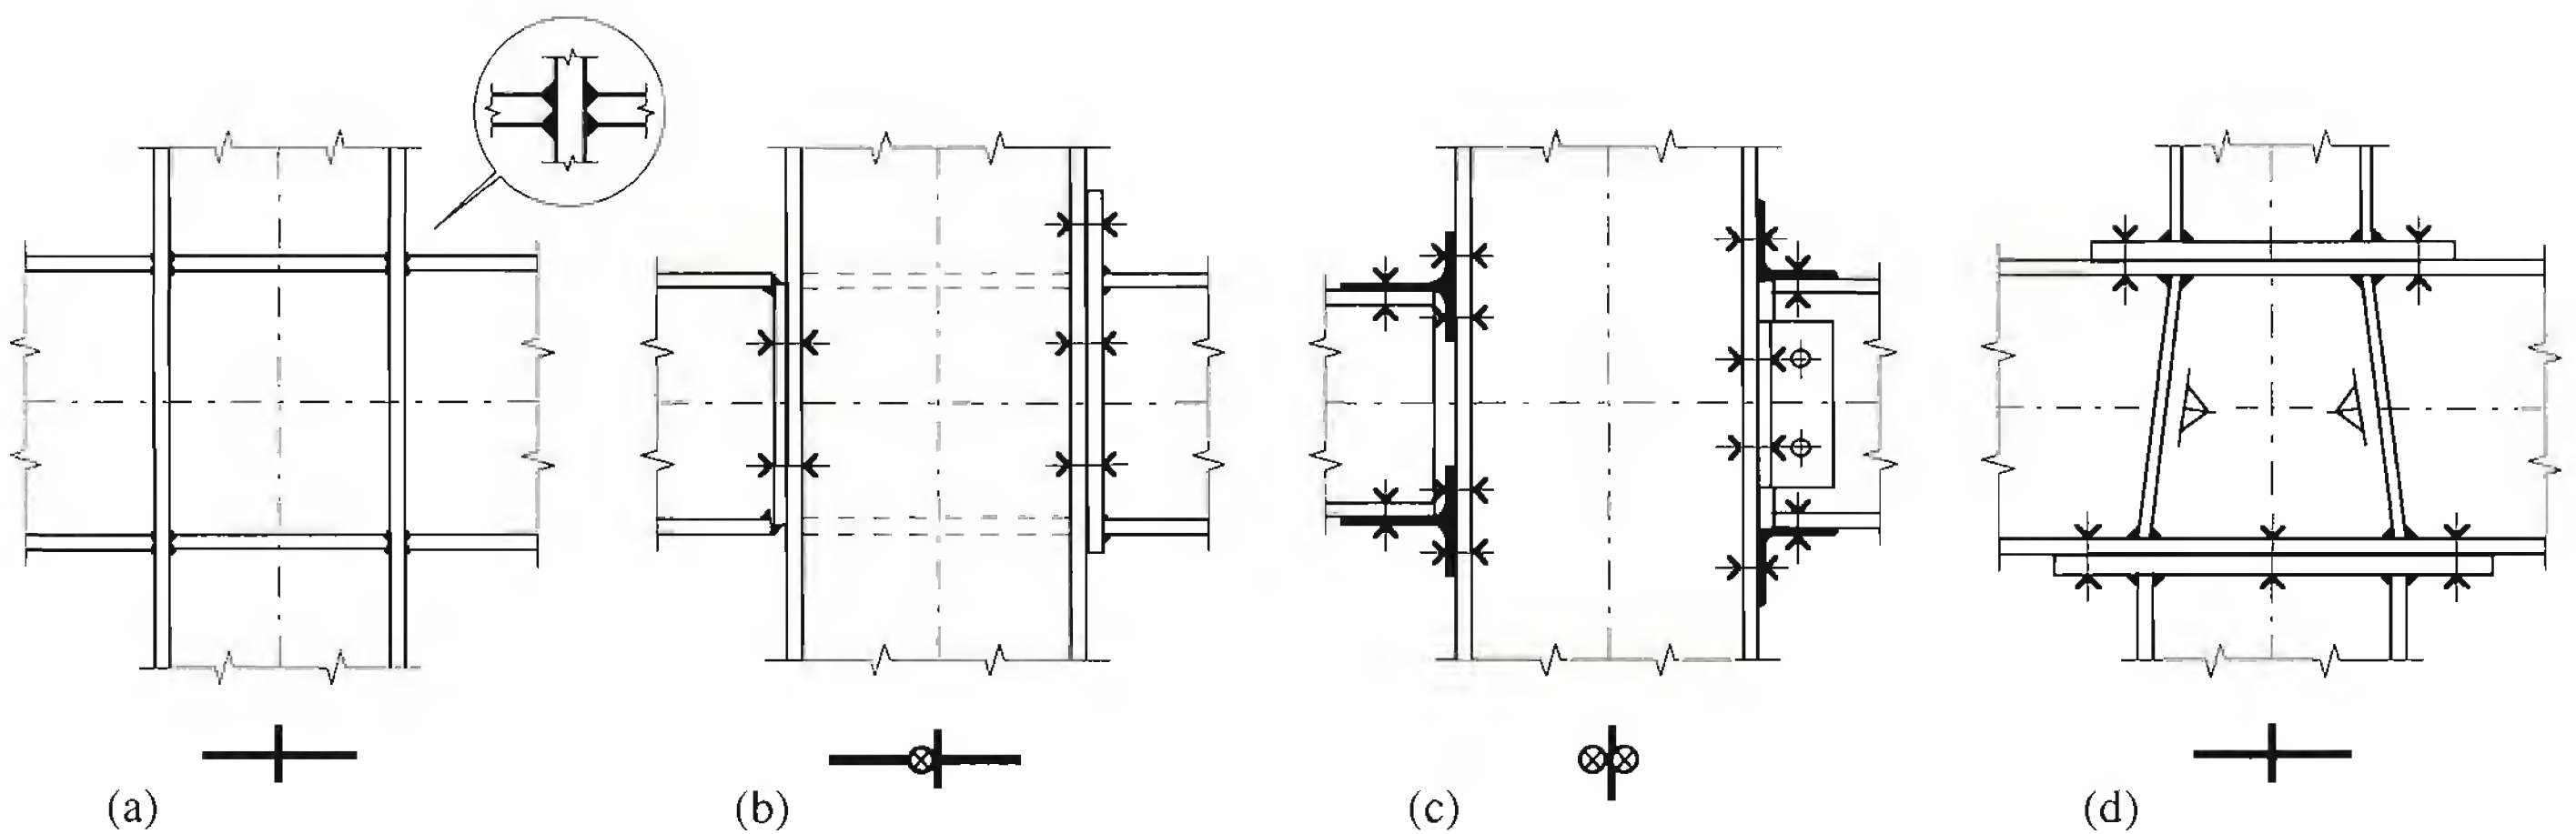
Assemblages poutre-poteau rigides et schémas des conditions d'appui.
